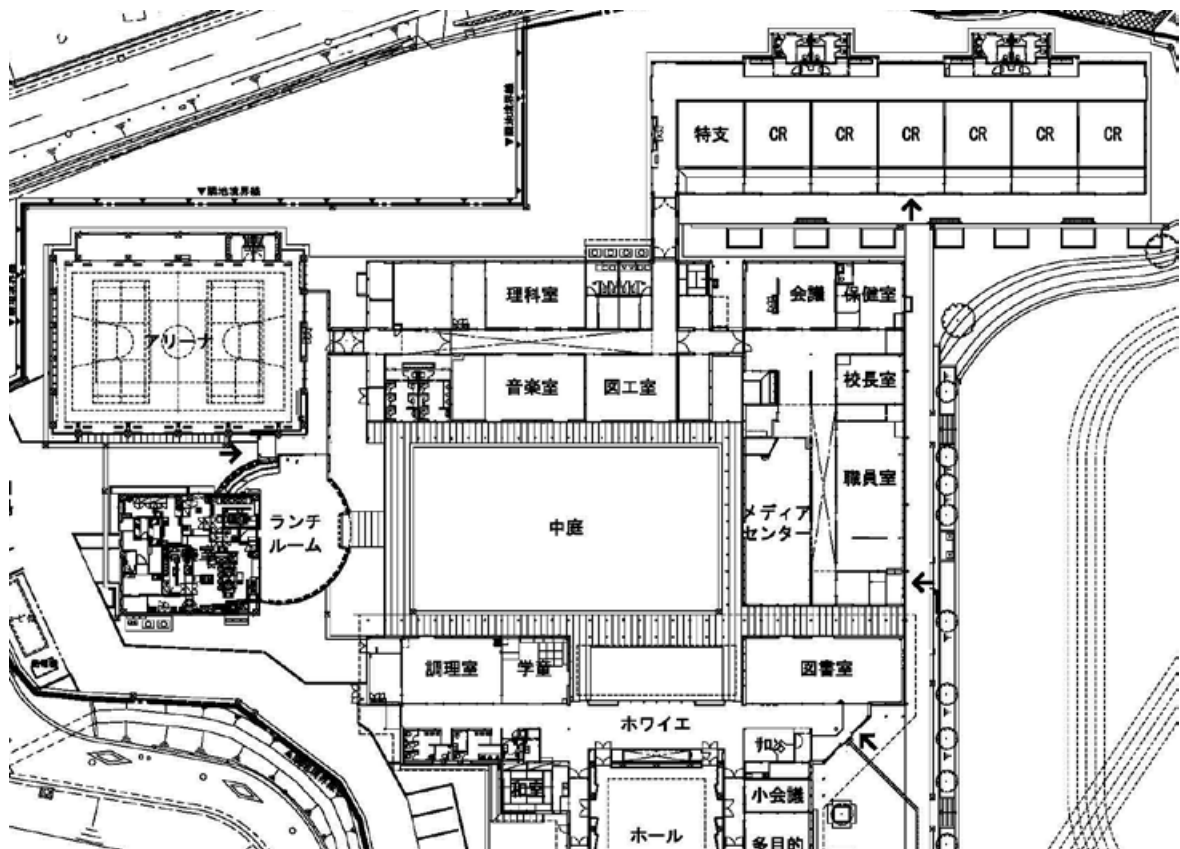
作手小学校平面図（中庭を挟んで南は交流館）
